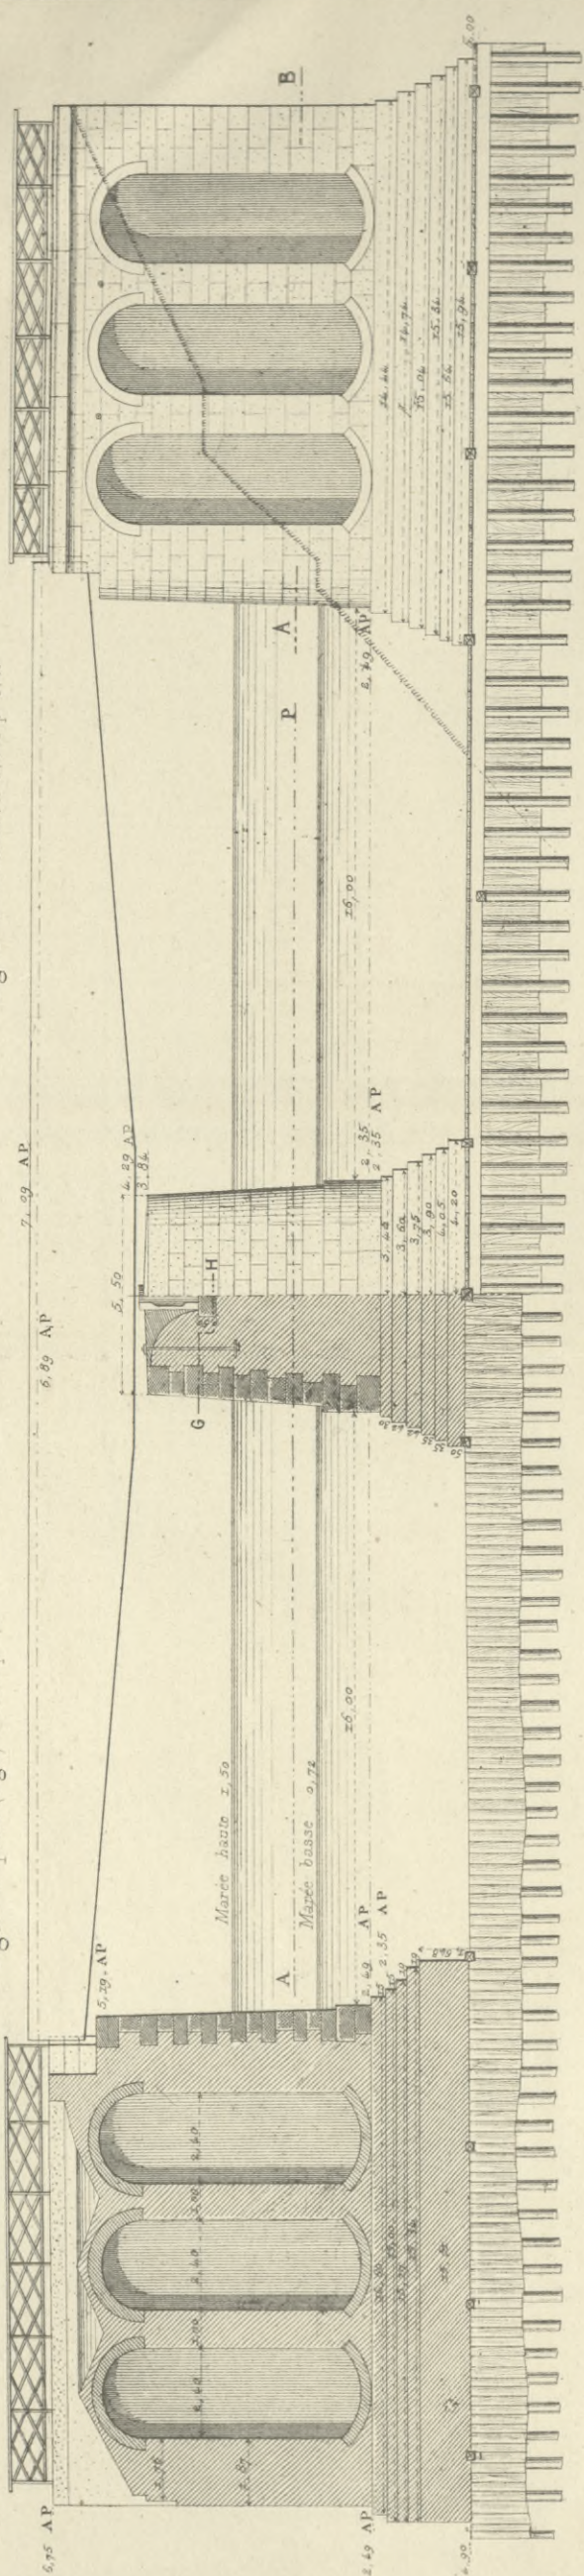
Plan et Coupe horizontale à 0^m005 p^r 1^m00
